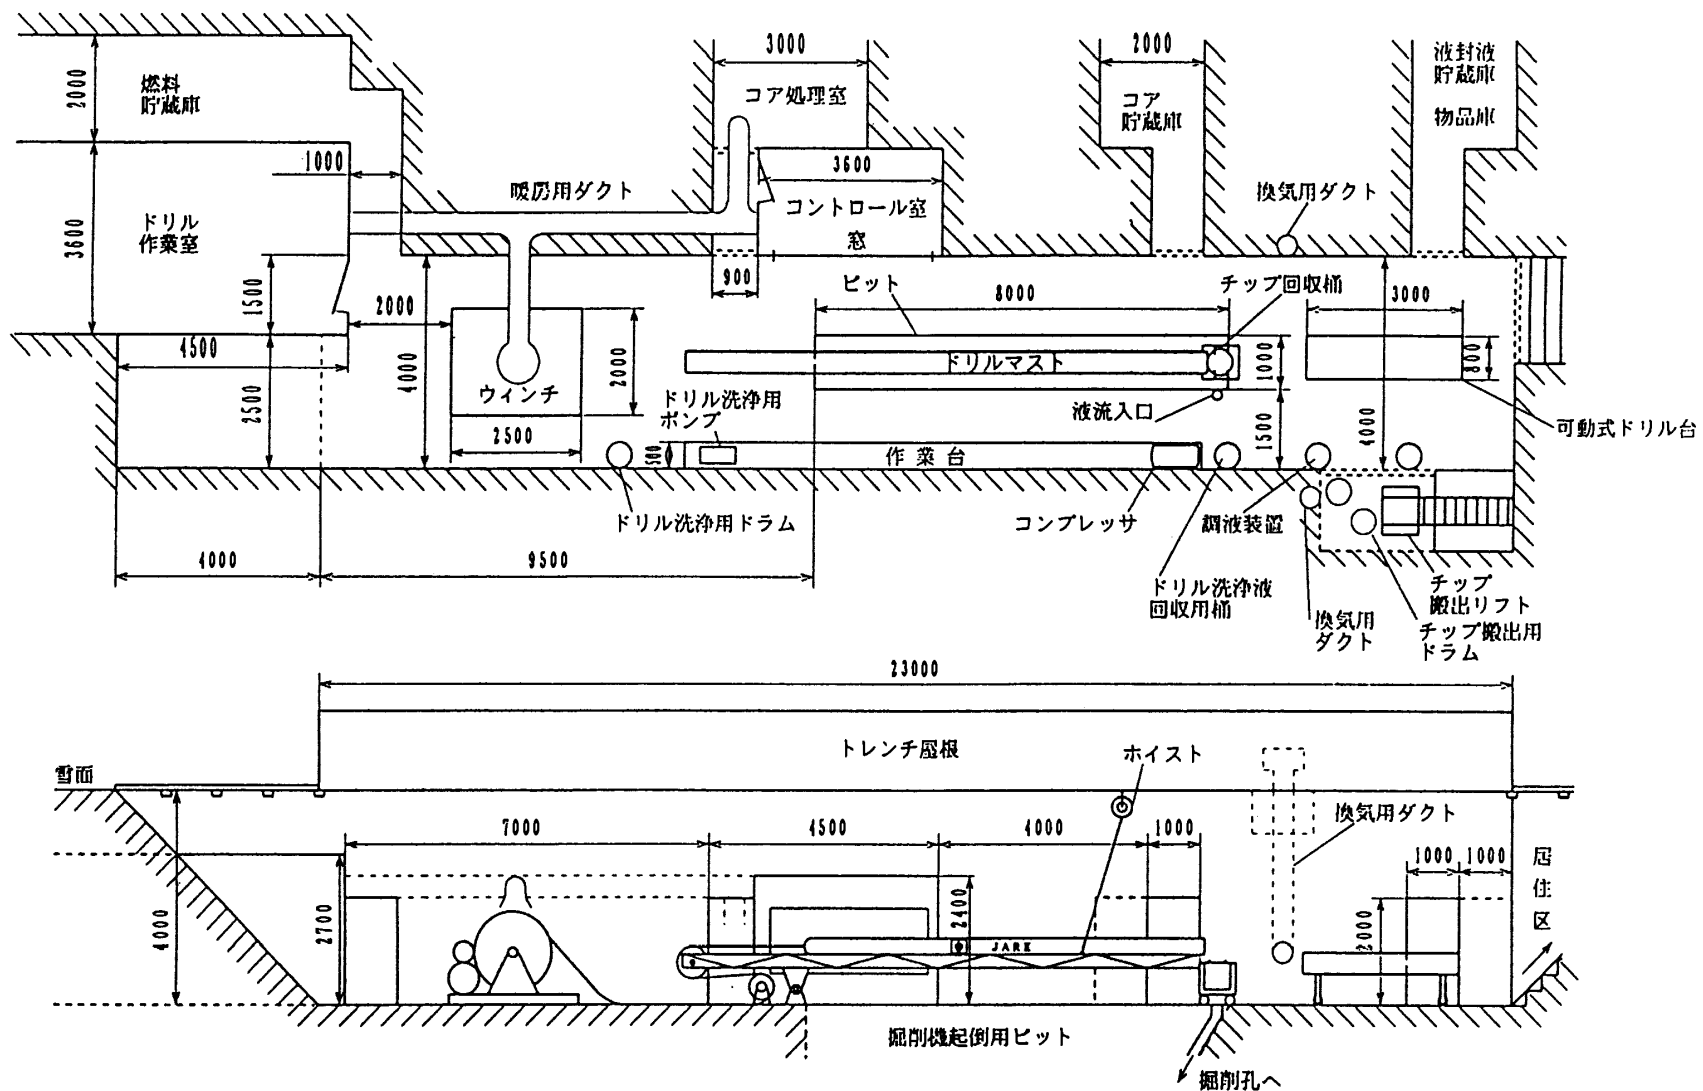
掘削場全体配置図 (mm). 上が平面図, 下が側面図
